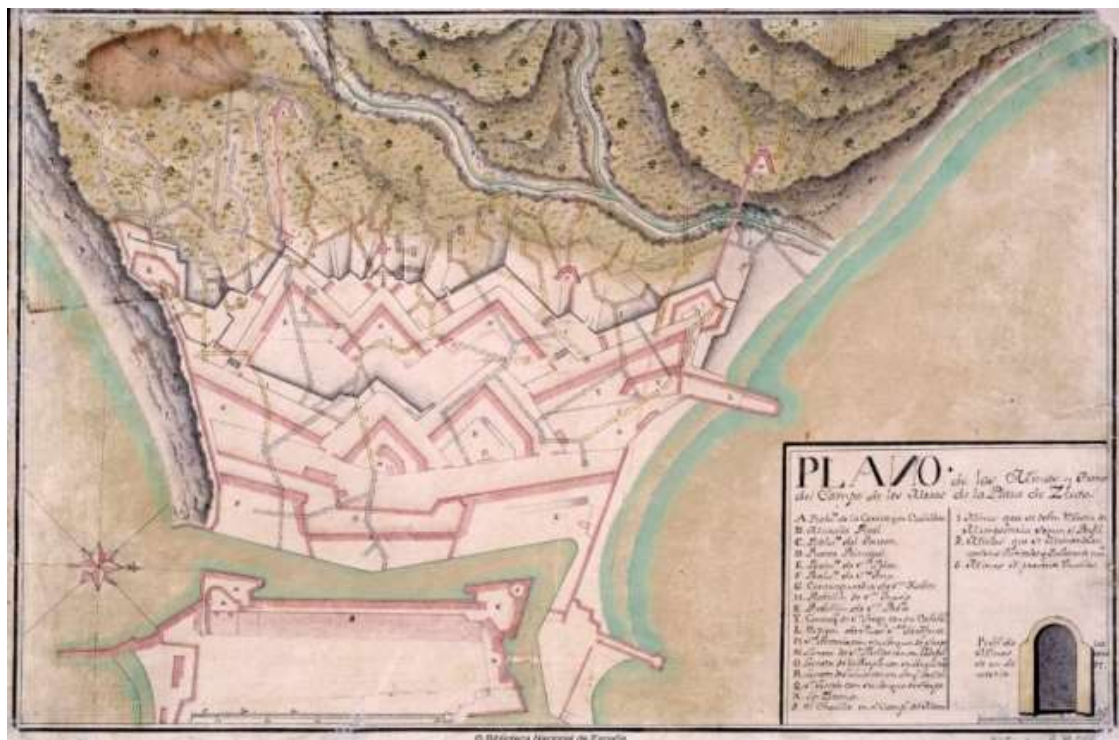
Plano de las Murallas Reales. | Biblioteca Nacional de España (1750-1800)
